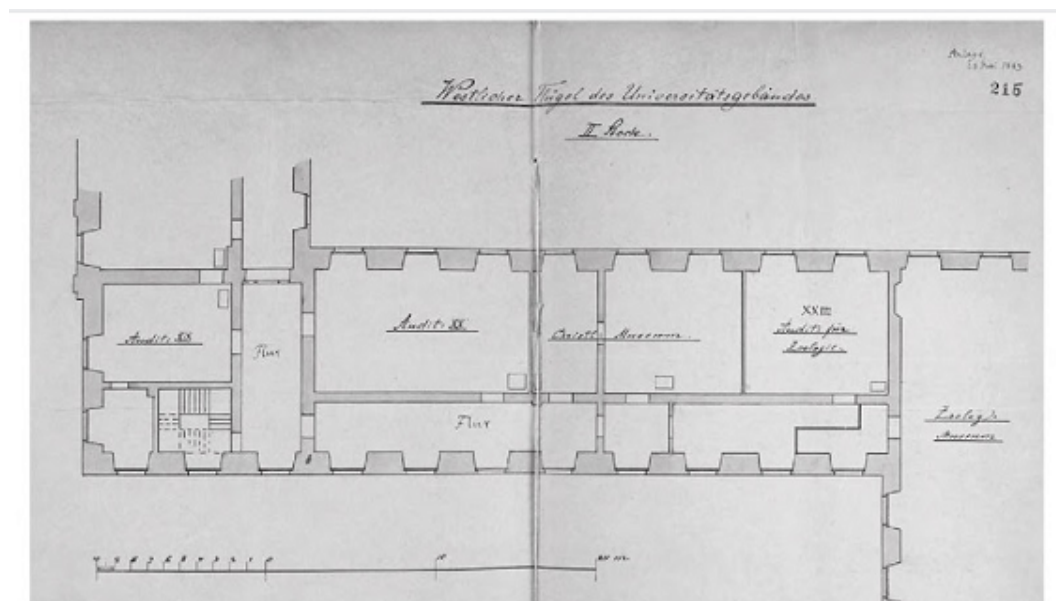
Das Christliche Museum, Grundrisszeichnung, Westflügel des Universitätshauptgebäudes.
